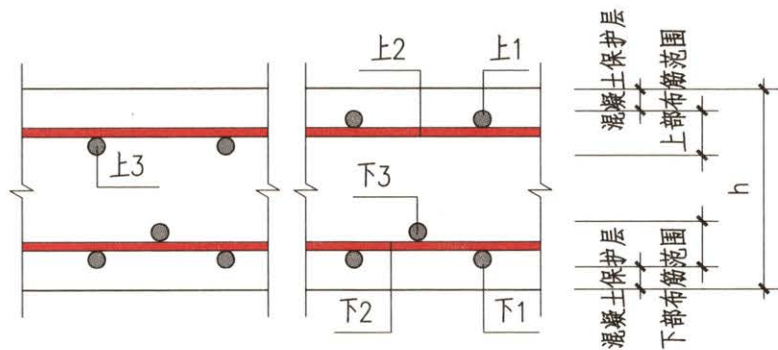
板厚范围上、下部各层钢筋定位排序表达示意
